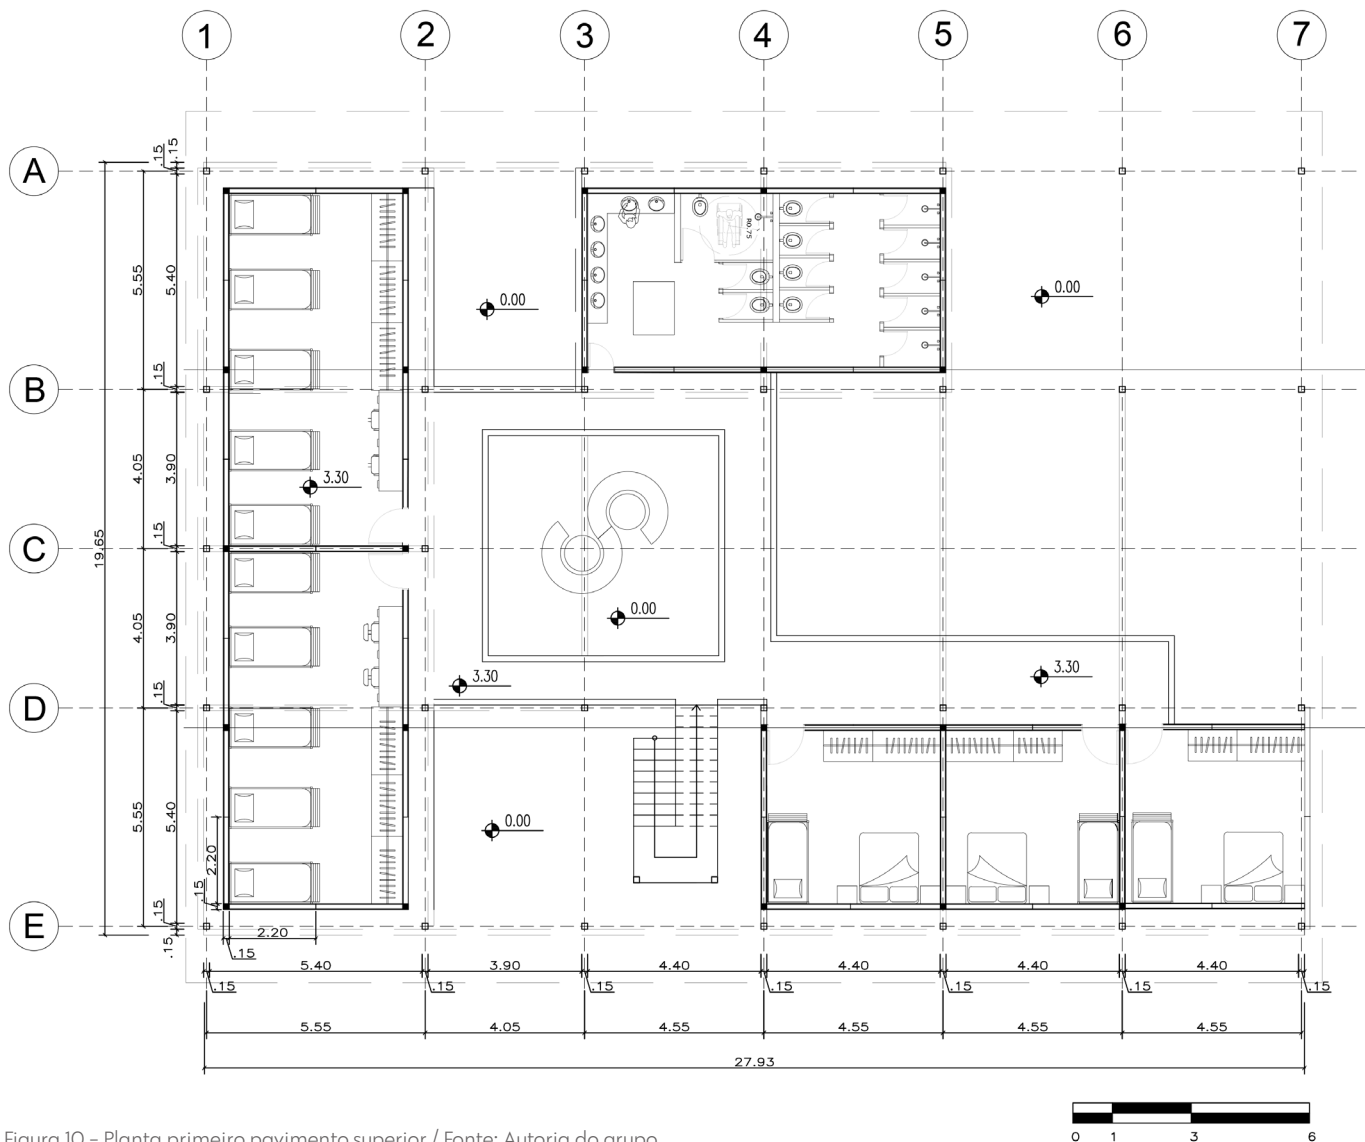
Planta primeiro pavimento superior / Fonte: Autoria do grupo.
